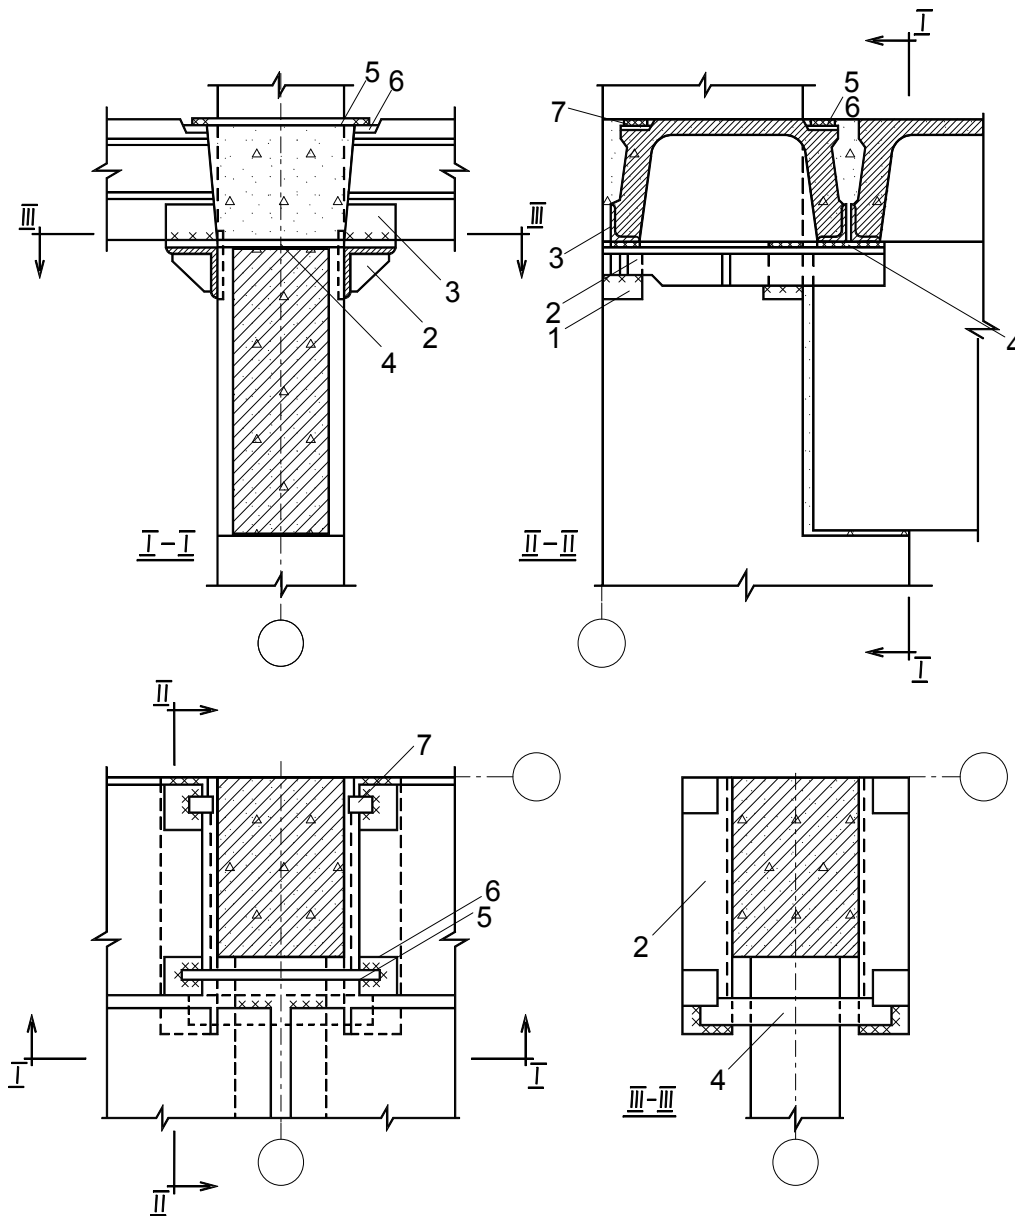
Деталі кріплення плит перекриття при ригелях прямокутного перерізу: 1 – закладні деталі колони; 2, 3 – закладні деталі плити перекриття; 4 – сталеві планки, встановлені зверху ригеля; 5 – накладки зі смугової сталі; 6 – верхні закладні деталі пристінних плит; 7 – коротиш з прокатного кутика, приварений в розпір з колоною
